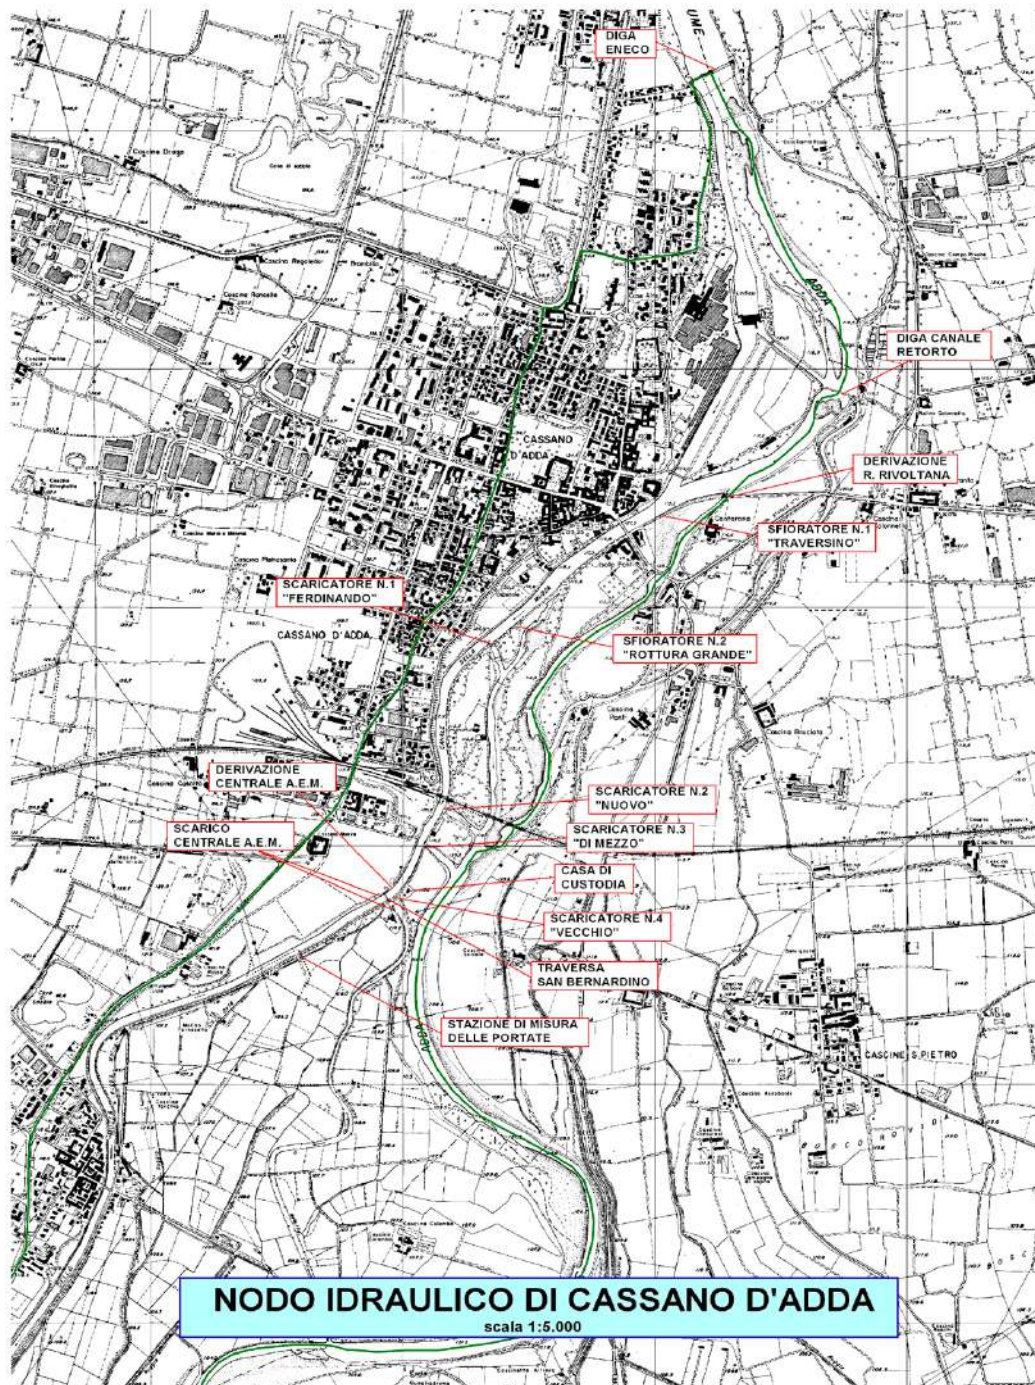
Planimetria del nodo idraulico di Cassano d'Adda.
